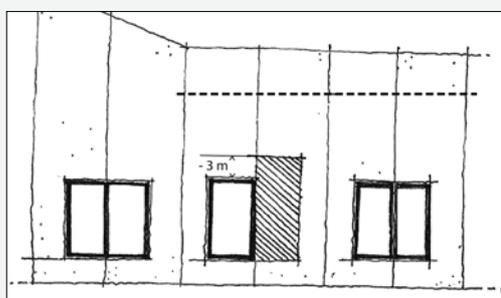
C : profondeur maximale de la zone bâissable dans le cas d'une construction de type trois façades (art. 4, § 1<sup>er</sup>, 2° c).
